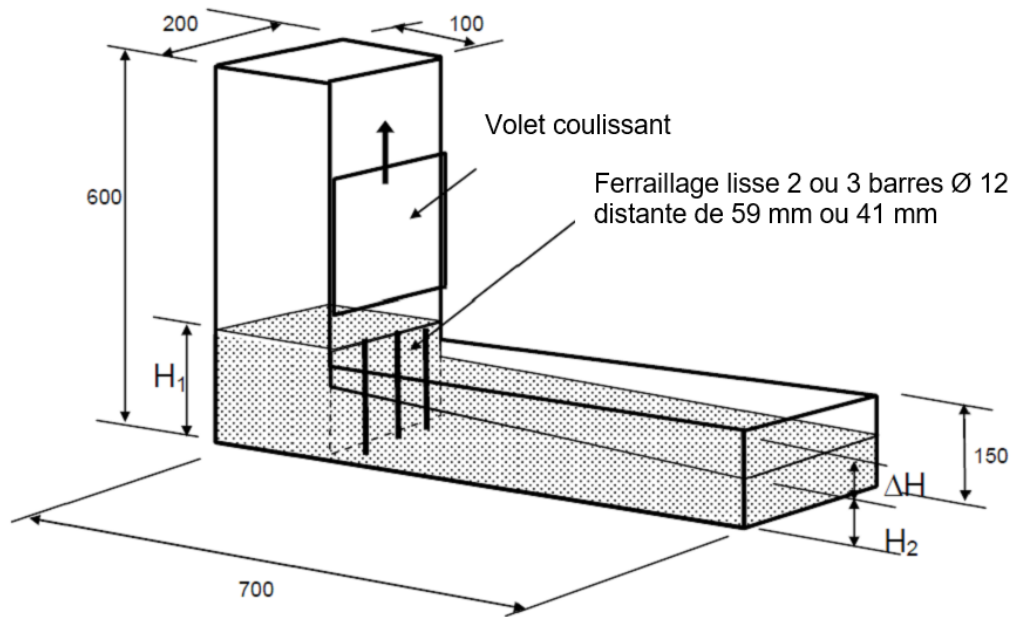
Essai d'écoulement à la boîte en L [12].
